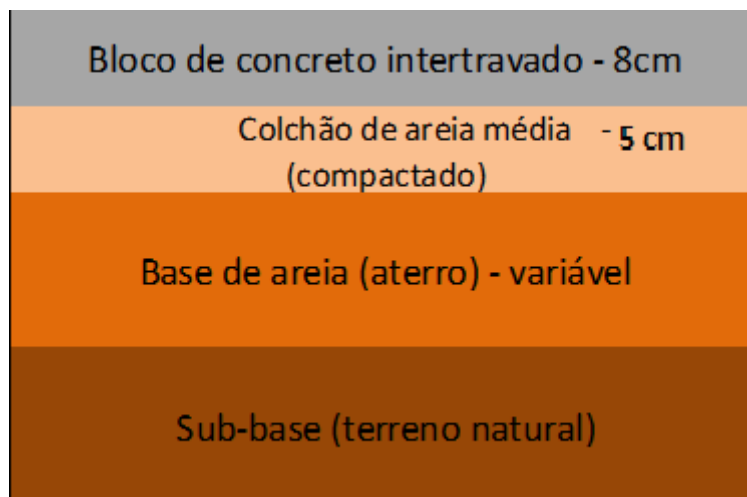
Camadas do pavimento de bloco de concreto intertravado
